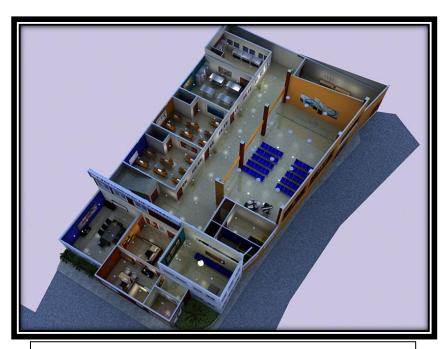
Perspectiva Arquitectónica Primer Nivel
